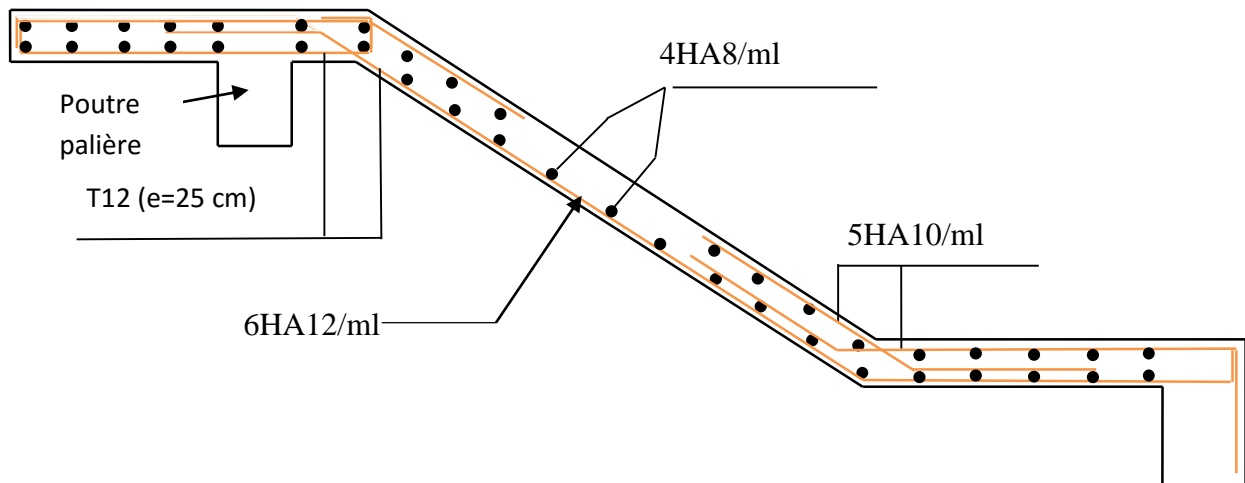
Schéma de ferrailage de la volée 1 et 2 de l'escalier.
